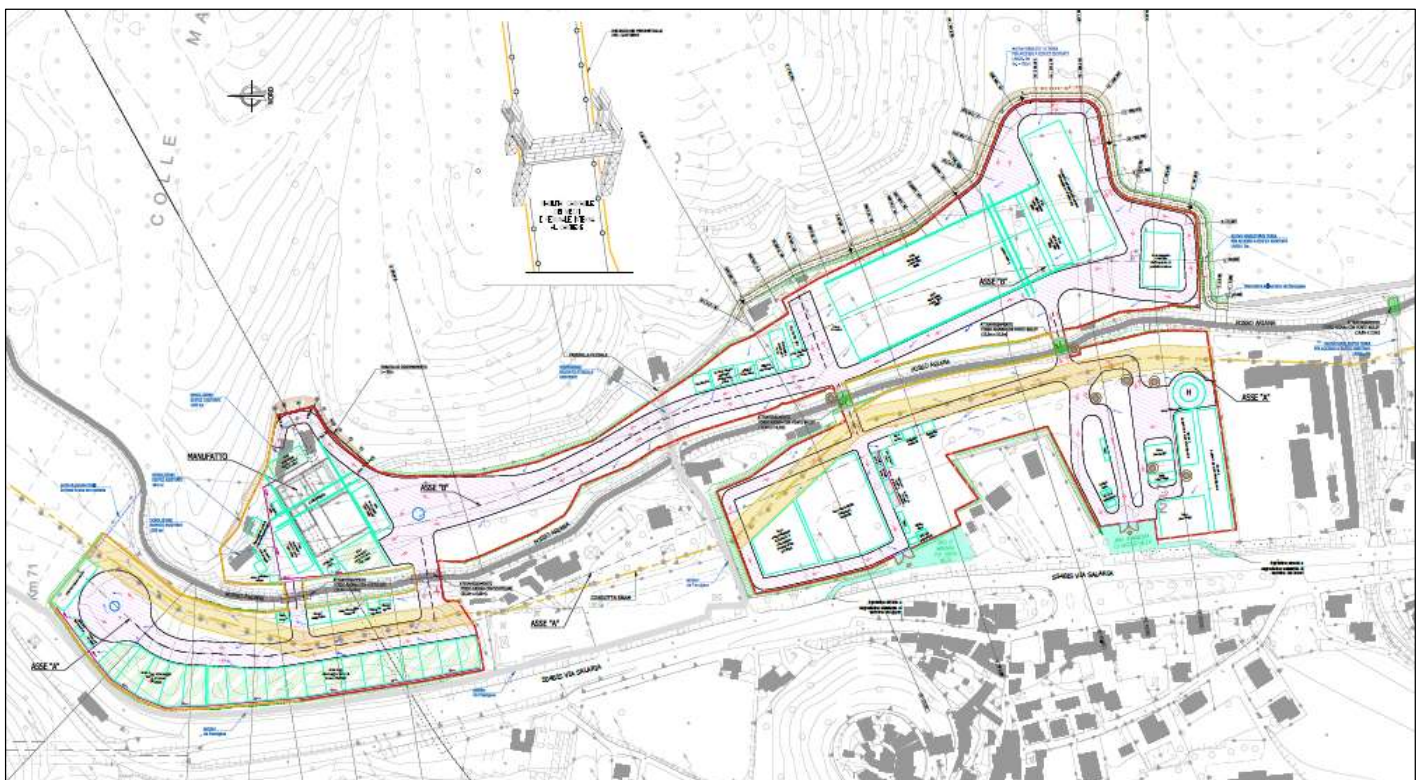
Area di cantiere SGR – Viabilità di accesso
